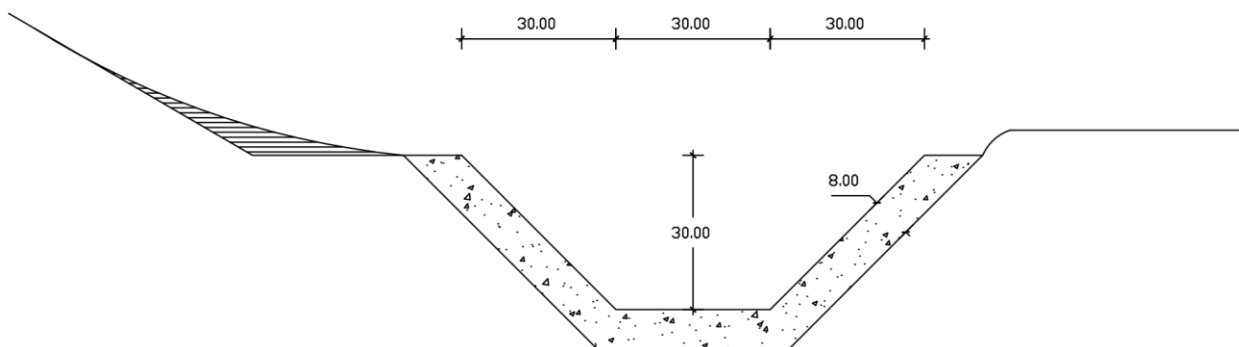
Esquema ilustrativo com dimensões da canaleta trapezoidal (medidas em centímetros)
